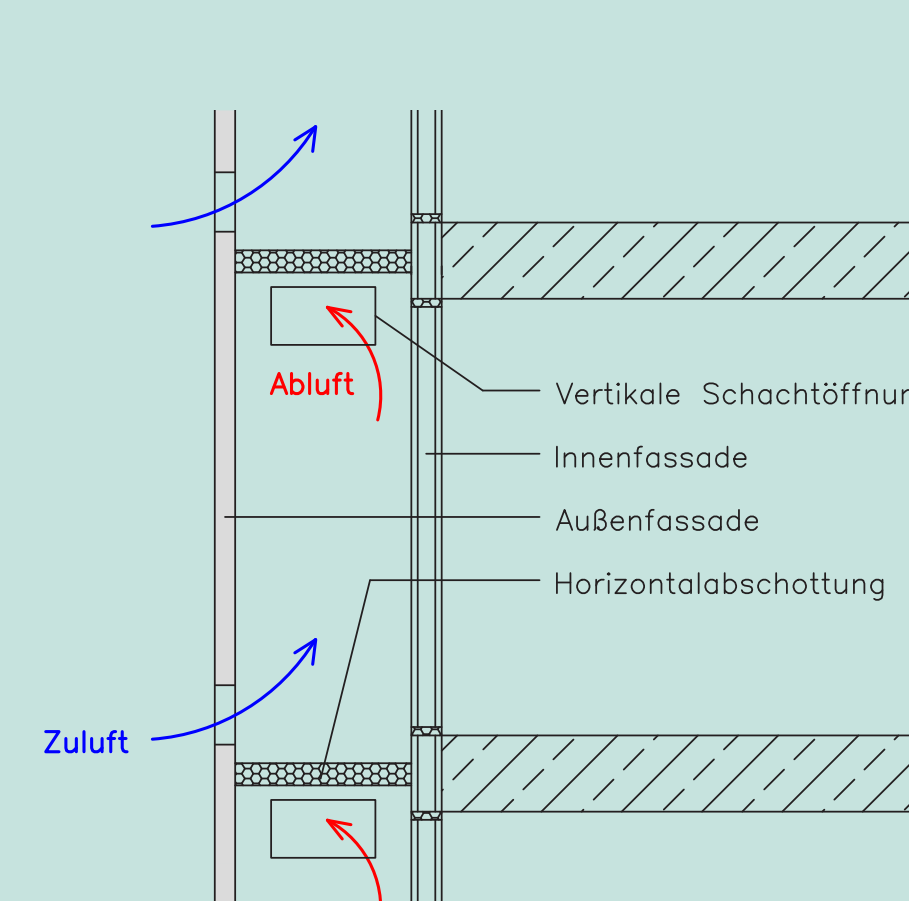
Funktionsskizze einer Schacht-Kasten-Fassade
